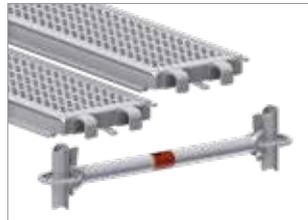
Beläge mit Auflagerklauen zur Auflagerung auf O-Riegeln/Konsolen
